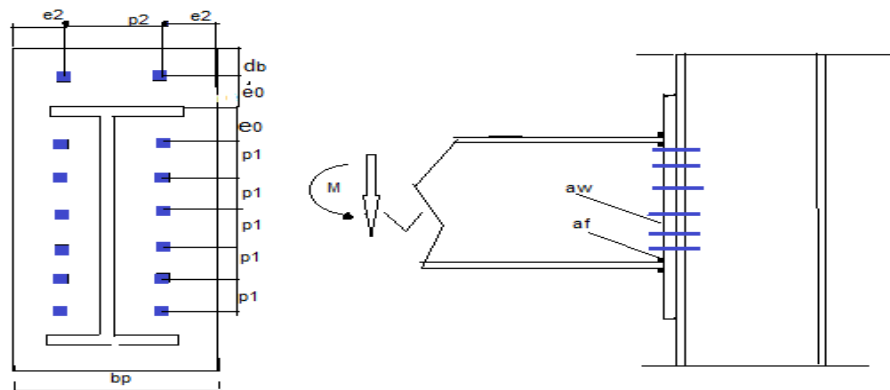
schéma de l'assemblage poteau – poutre à vérifier .
